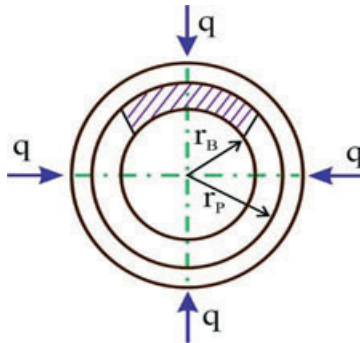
Расчетная схема к определению нагрузки на крепь при сплошном сводообразовании
